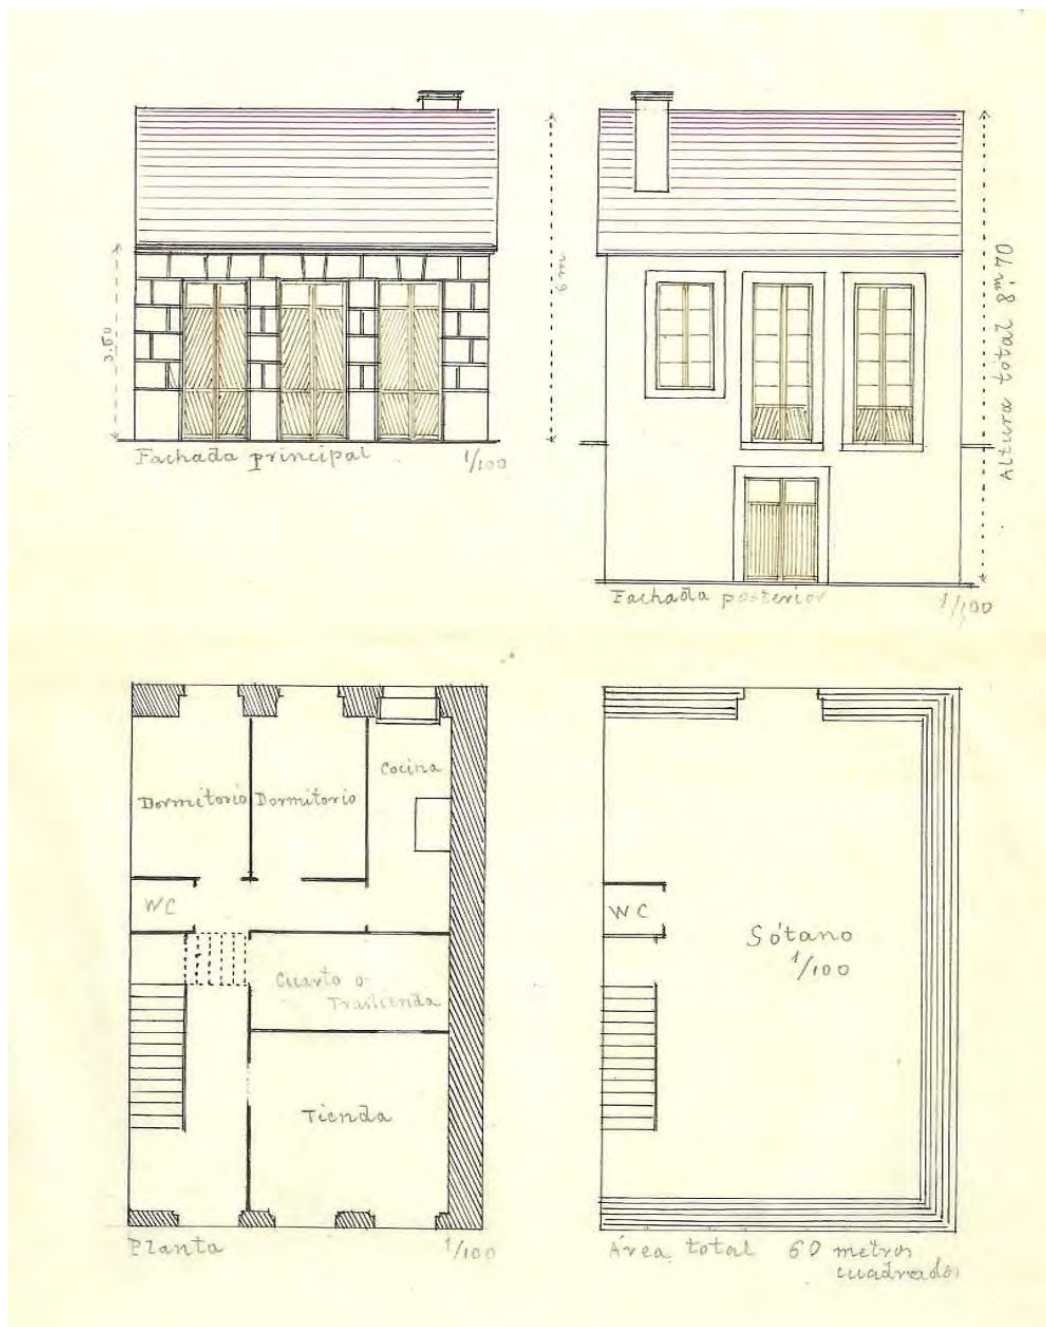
Planos de las distintas partes de la casa: Fachada principal, fachada posterior, distribución de planta y sótano
